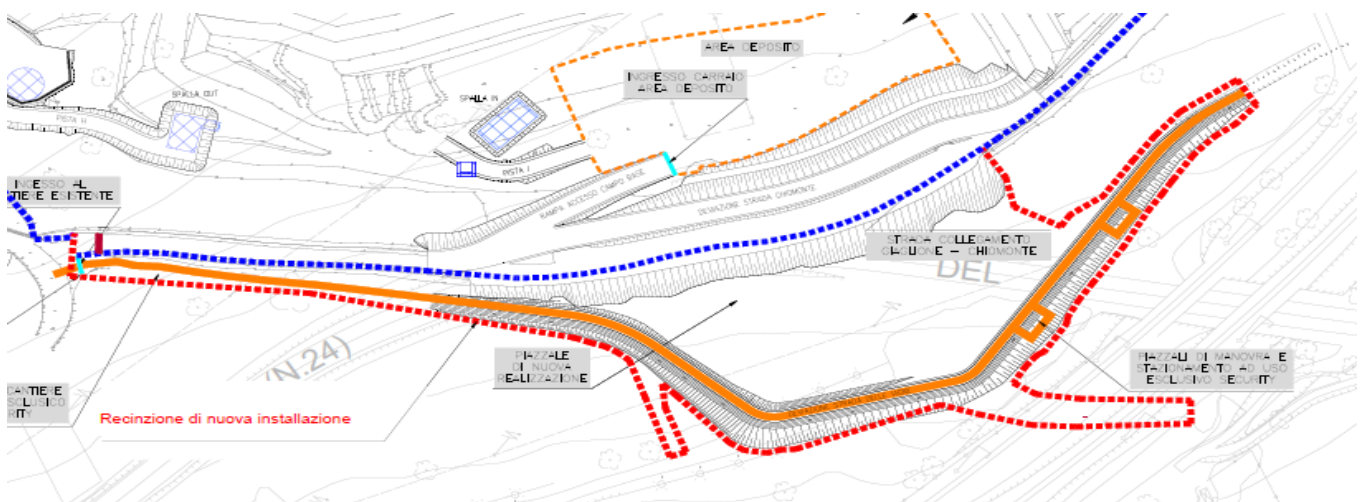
Stralcio planimetrico Strada di vigilanza delle Vigne
